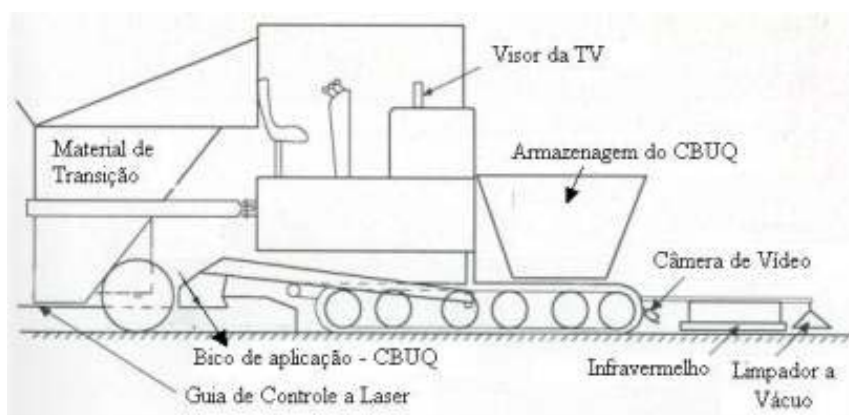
Desenho esquemático da máquina pavimentadora (modificado - Höeg ,1993).
